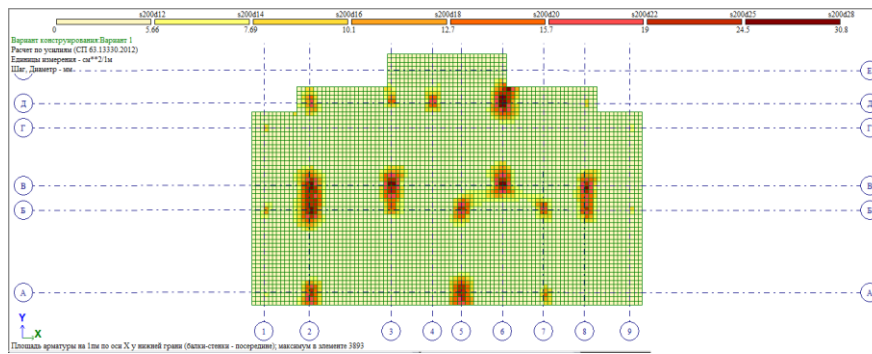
Схема нижнего армирования фундаментной плиты по оси X
